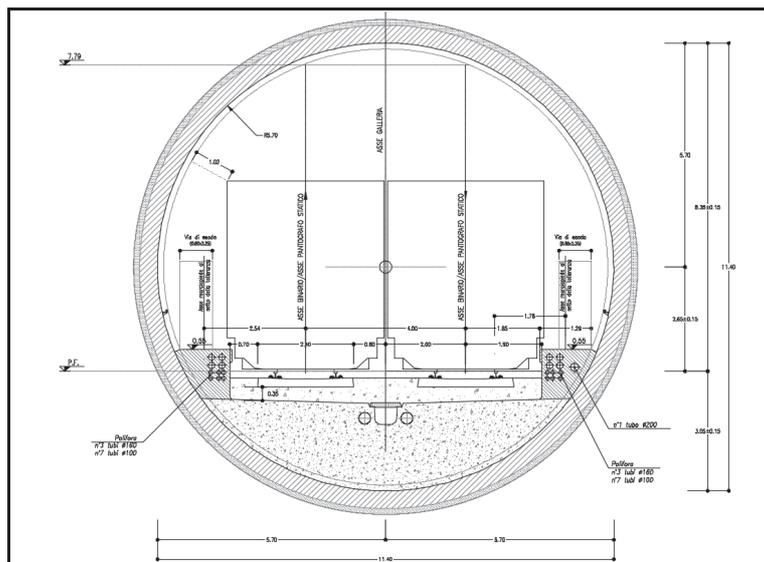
Sezione di intradosso galleria di linea per scavo meccanizzato (sezione corrente).
